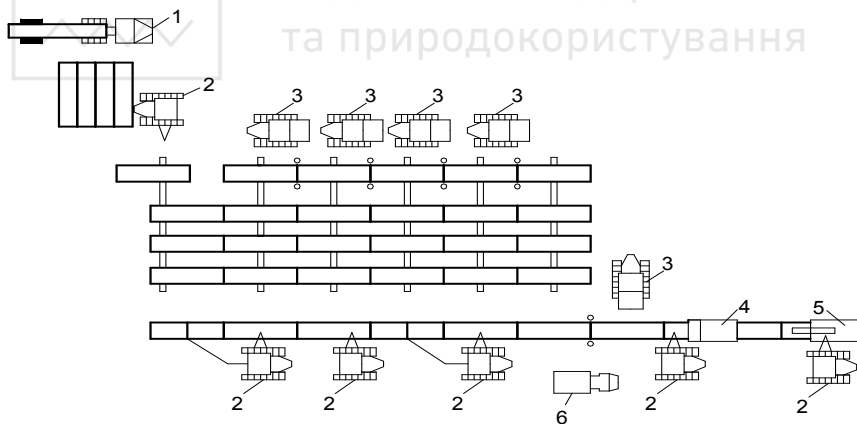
Схема виконання робіт зі сплаву трубопроводу з монтажної площадки із закріпленням анкерними пристроями:
